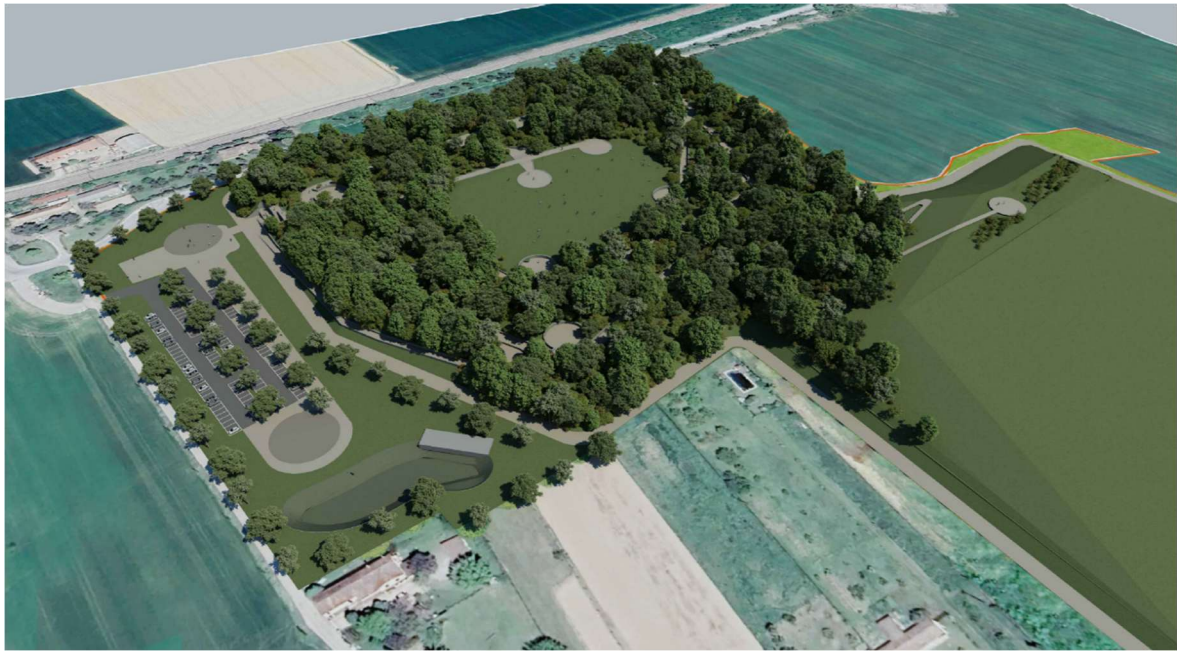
Vista Prospettica Aerea dell'Intervento di Rinaturalizzazione
